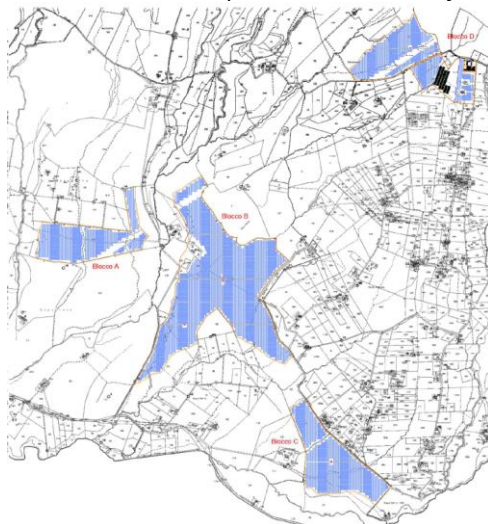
Elaborati di Progetto - Layout di Impianto (cfr. elaborato D14E01-Layout-Impianto.pdf)
